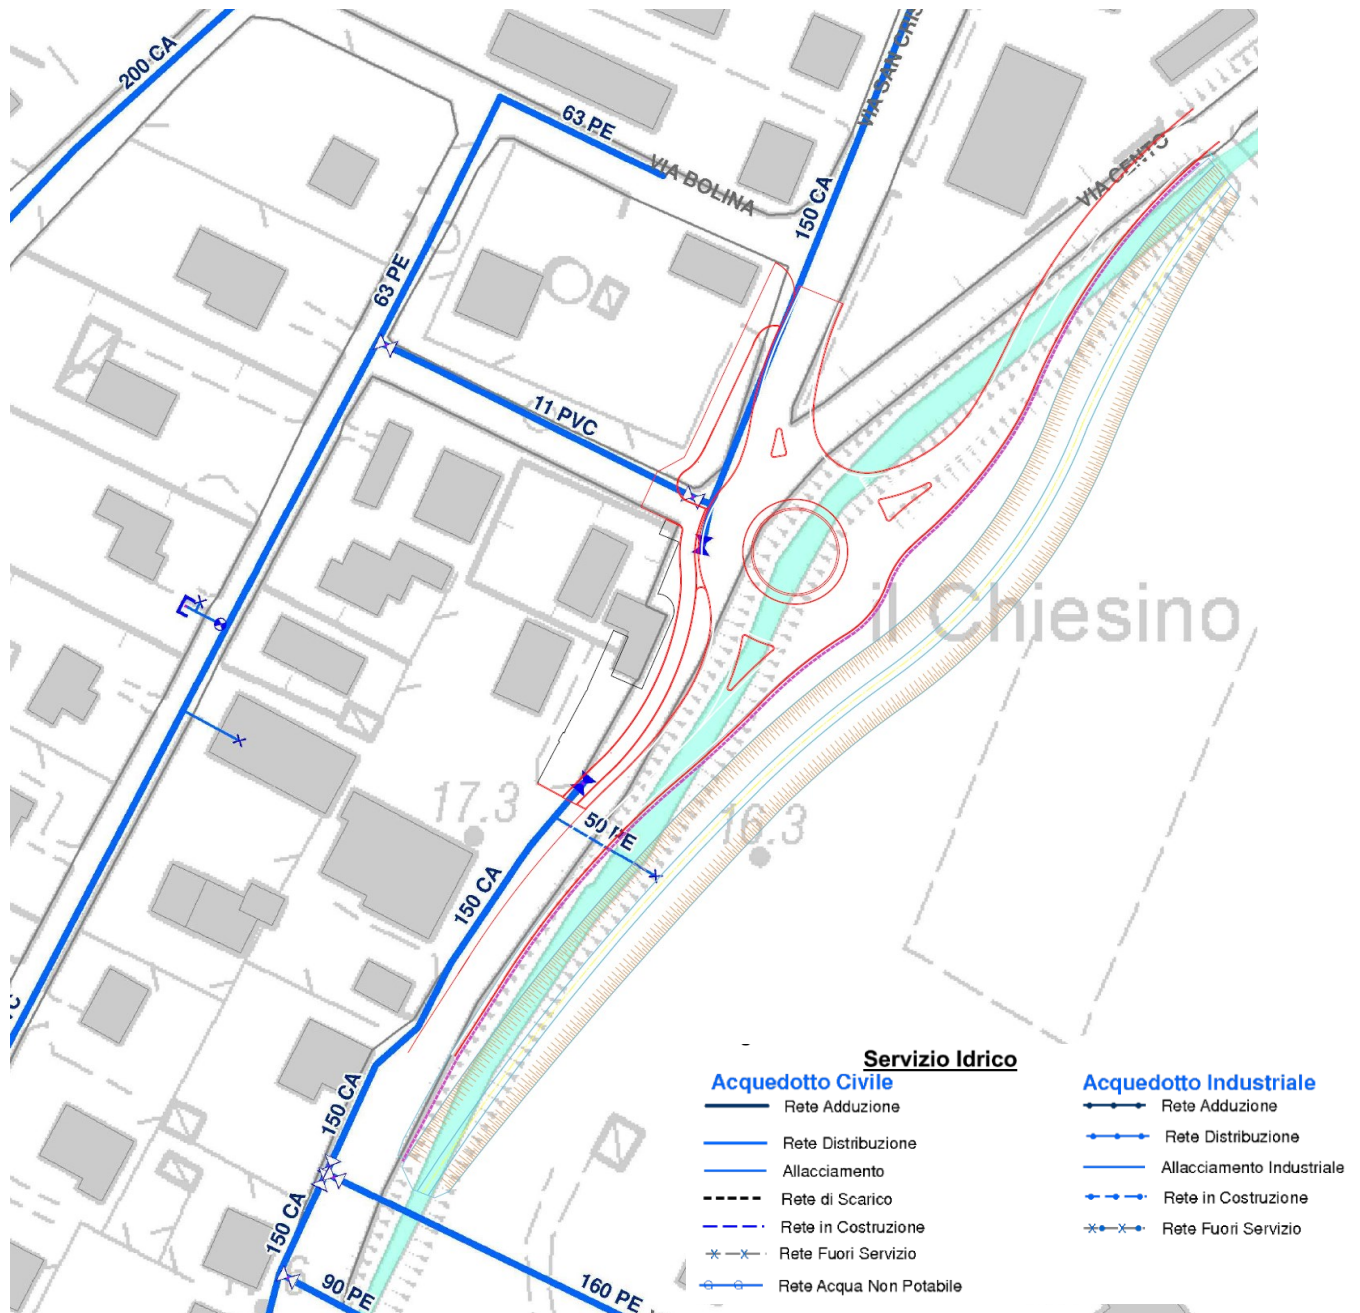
Sovrapposizione rete idrica con progetto
